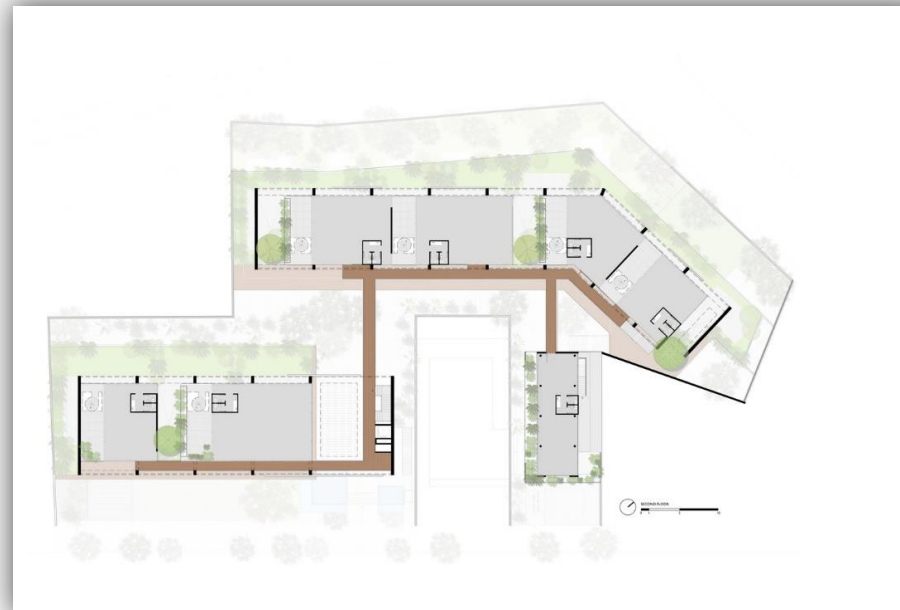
Planta Baixa 2º Pavimento- Fonte: archdaily.com.br
